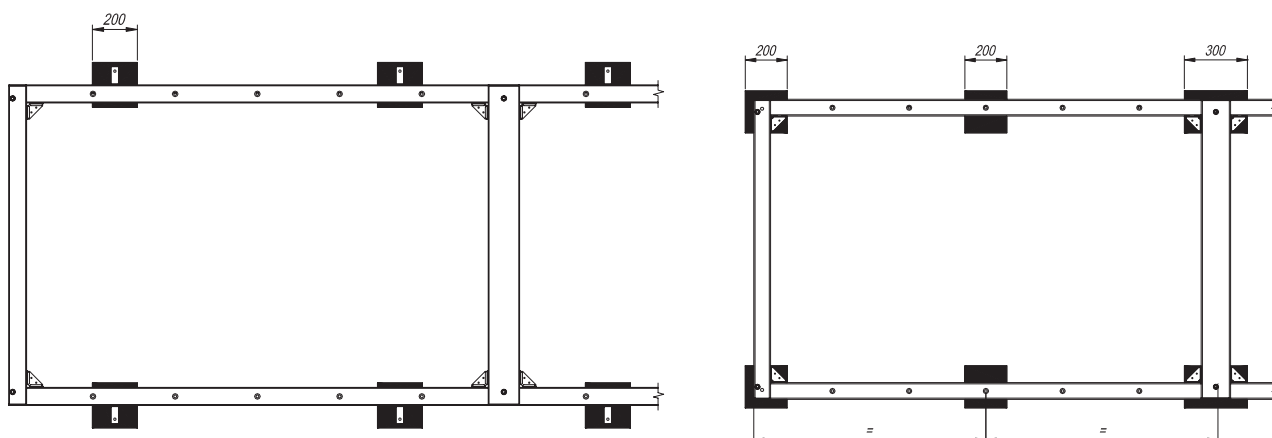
Usytuowanie skrajnych otworów fundamentowych w ramach nośnych bloków central
